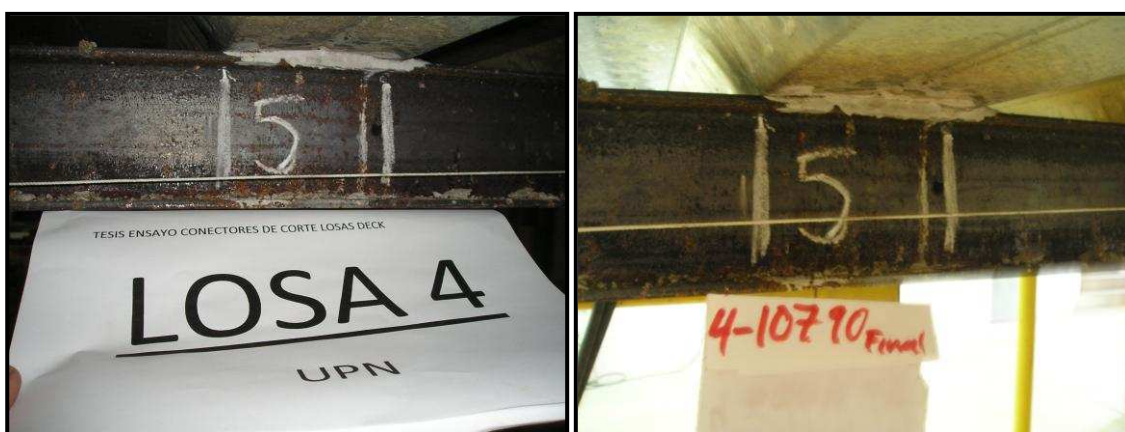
FISURAS PRESENTES EN EL ENSAYO
